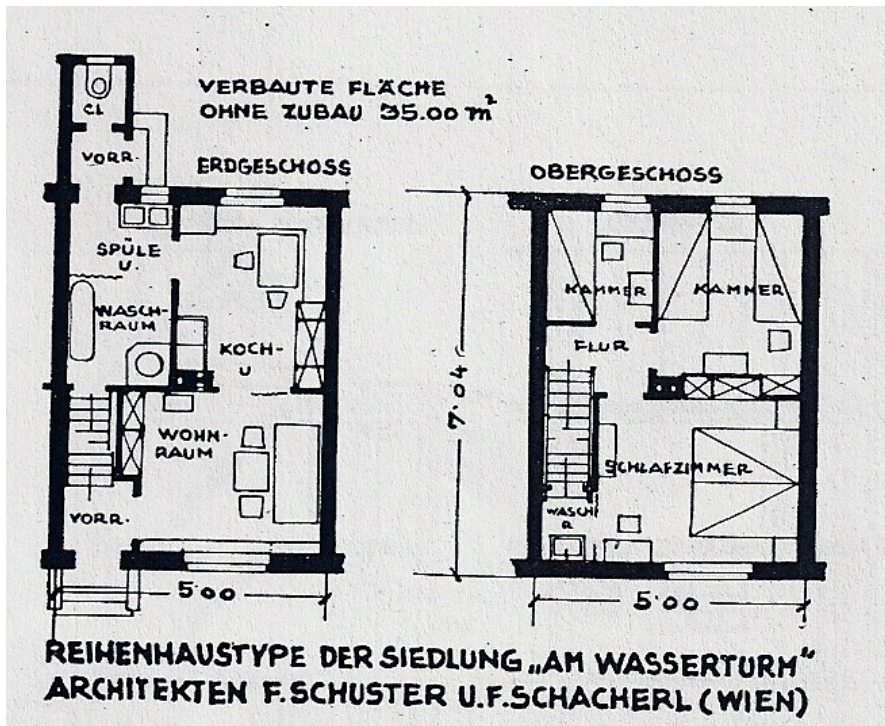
Grundriss eines Siedlungshauses der Siedlung „Am Wasserturm“, 1923/24, 1100 Wien.
